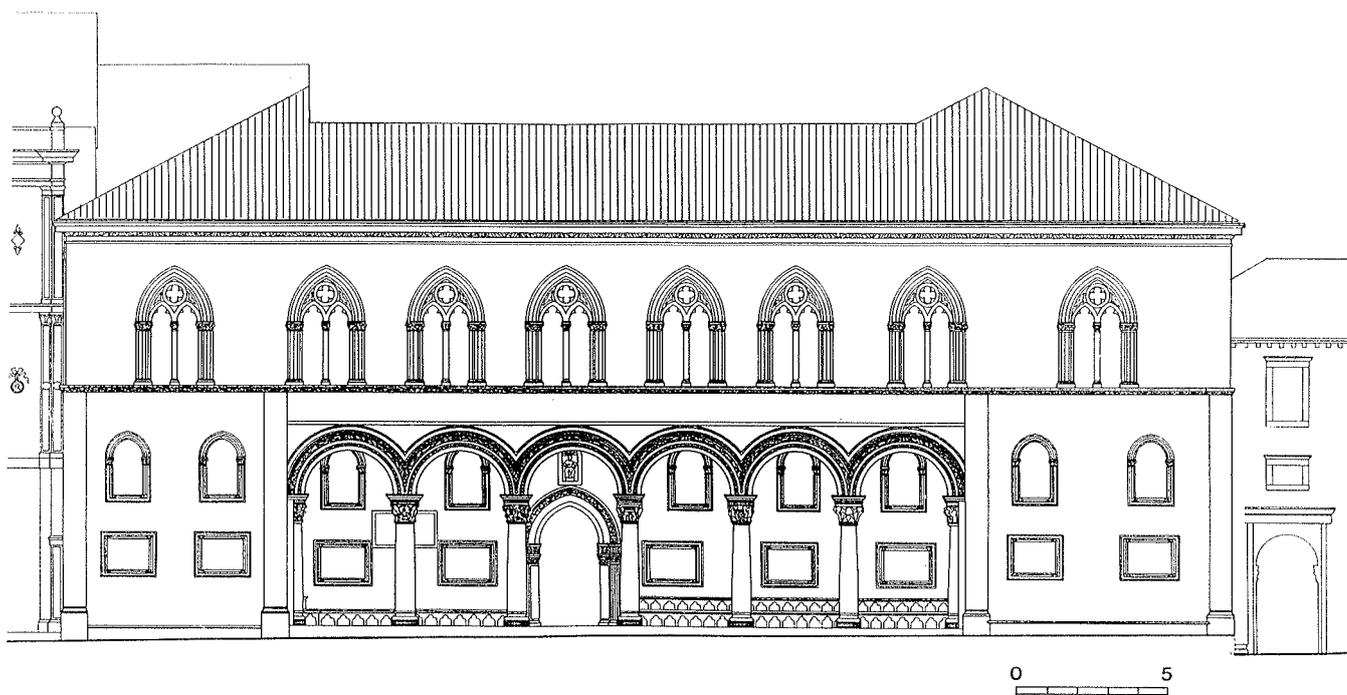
Palais du prince, façade, état actuel (Institut de l'histoire de l'art, Zagreb)
